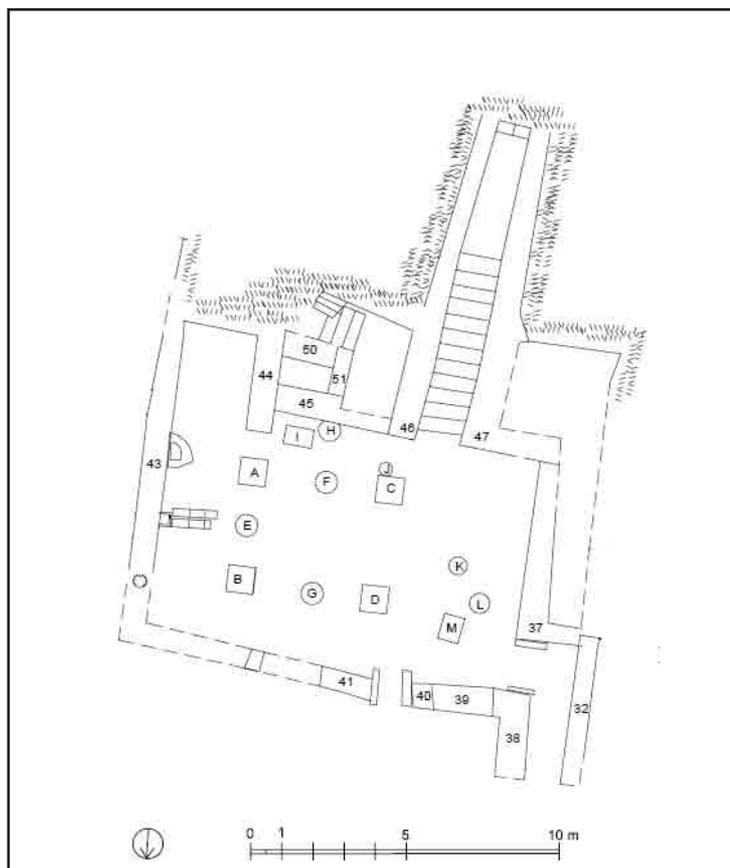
Planimetria risultante dal rilievo con numerazione delle unità murarie.
